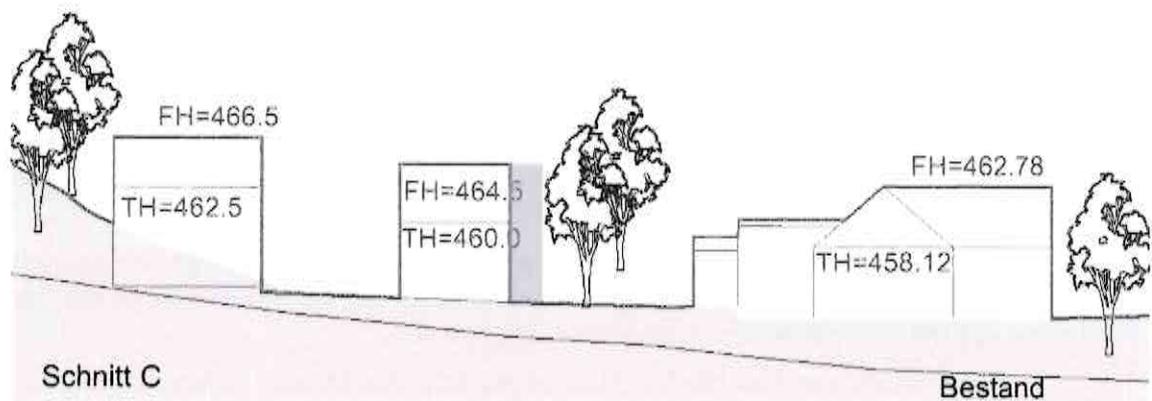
Schnitt C, schematische Darstellung einer möglichen Bebauung mit Satteldächern
